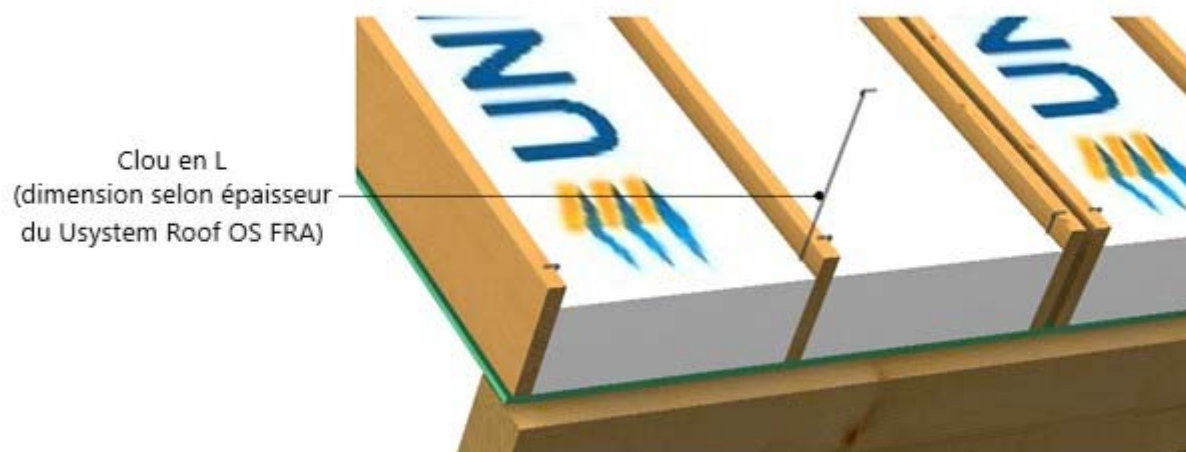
Fixation sur panne en bois du Ussystem Roof OS FRA
